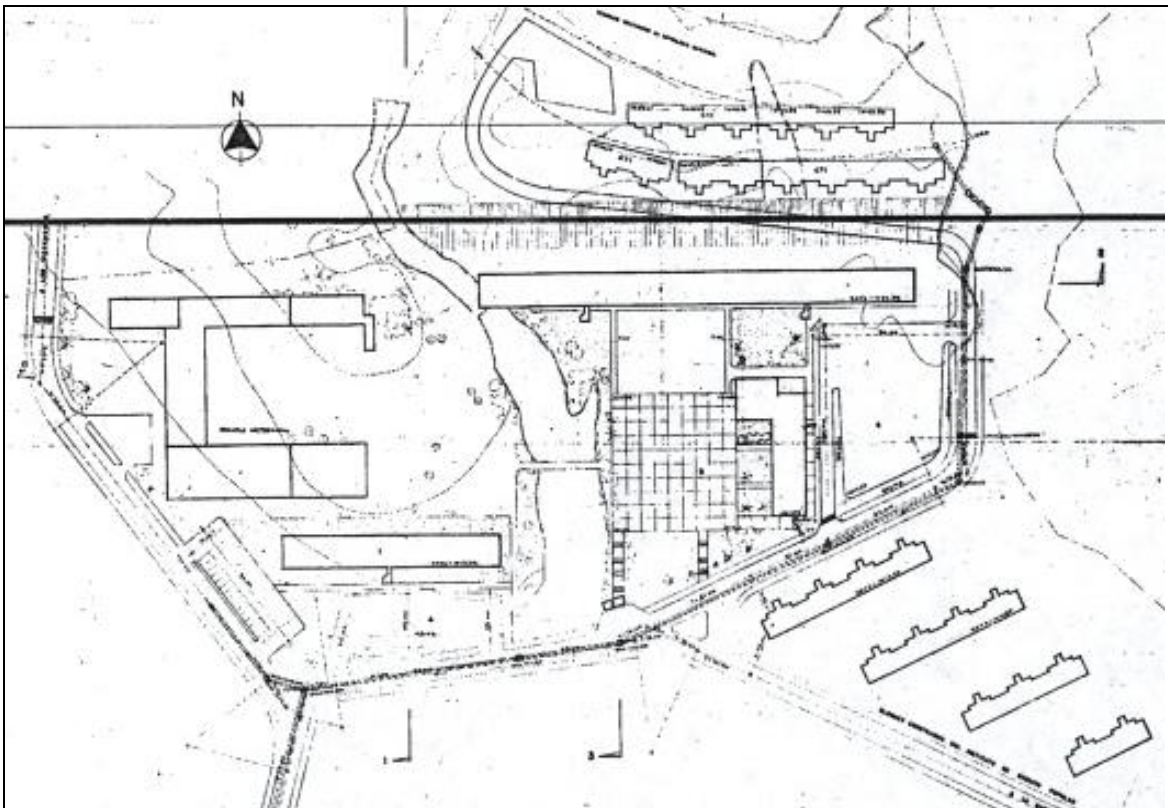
b. UR Diego de Losada. Plano de Conjunto (1954)
